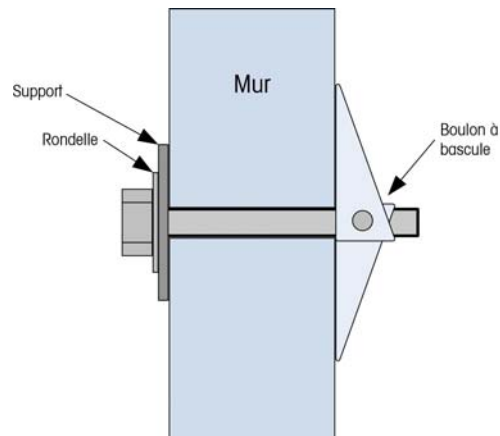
Installation sur panneau de revêtement ou cloison sèche
